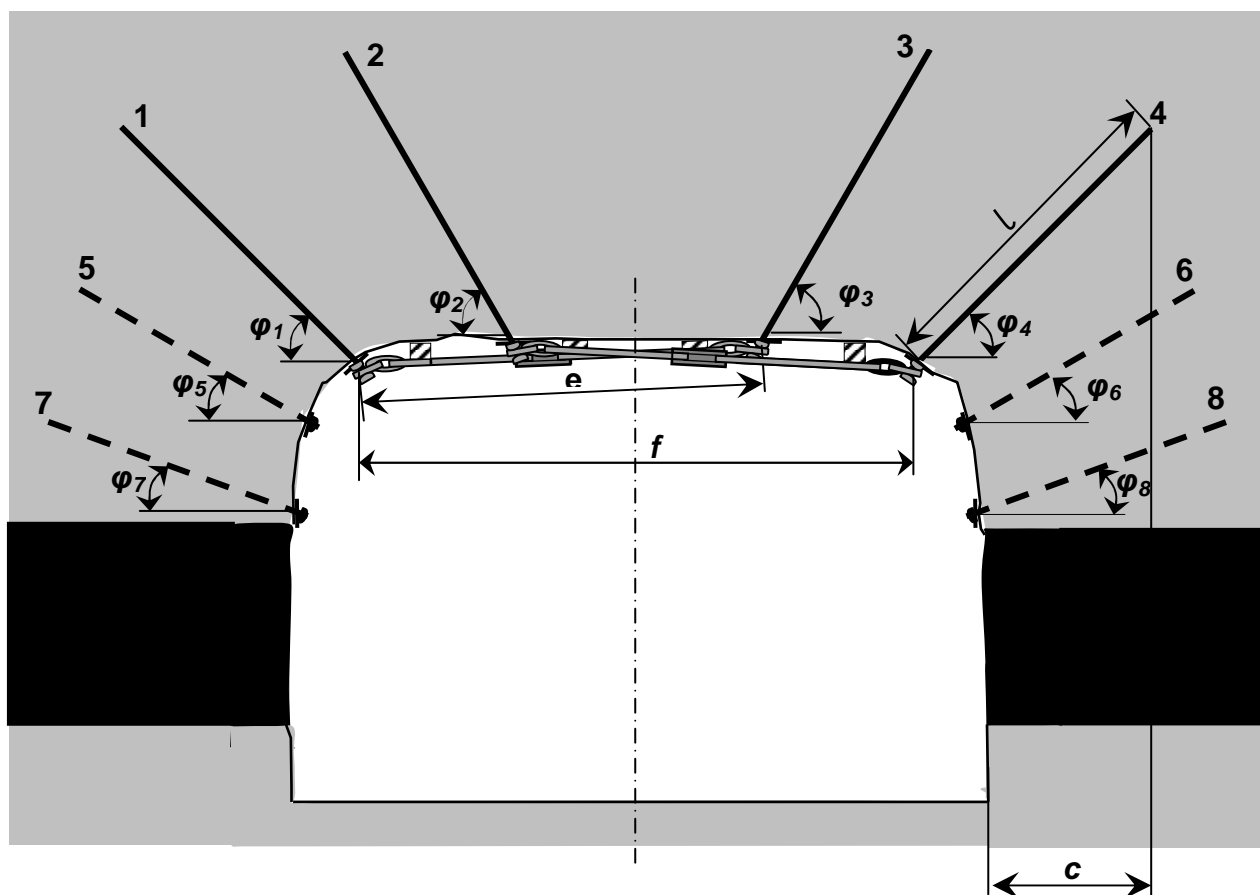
Анкерно-стяжная крепь в выработке с плоской кровлей
